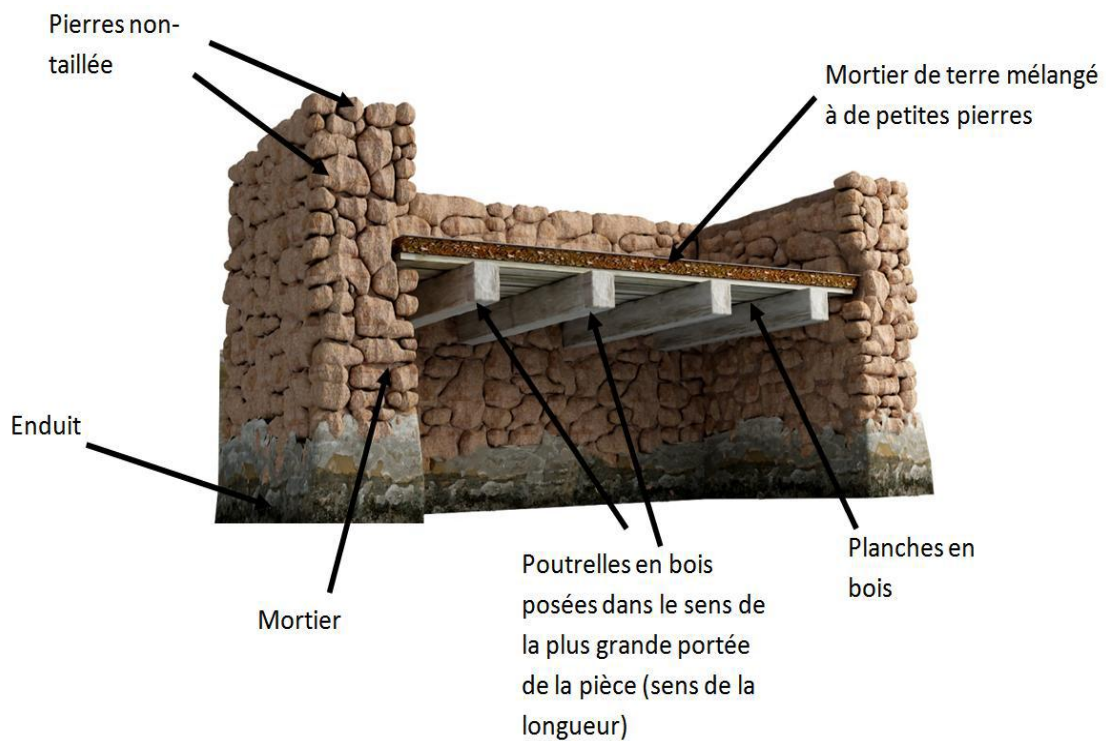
Matériaux et typologie constructive d'un plancher en poutrelles de bois
